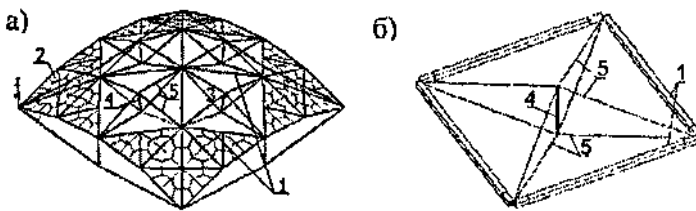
Многогранная сталежелезобетонная пространственная конструкция покрытия размером в плане 24x24 м с опиранием по углам; а - общий вид оболочки с разбивкой на КЭ; б - напрягаемая ячейка; 1-железобетонные элементы каркаса; 2-плиты покрытия; 3-напрягаемые системы; 4- центральный раздвижной элемент; 5-металлические тяжи.
